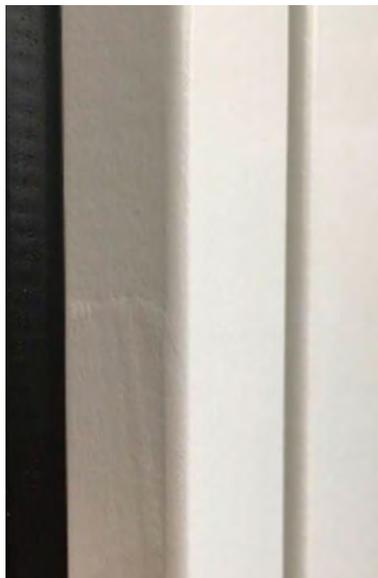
Fotoabbildung der IG Fenster Schweiz
